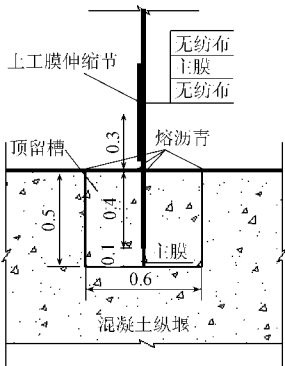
复合土工膜与混凝土纵堰相接剖面(单位:m)
